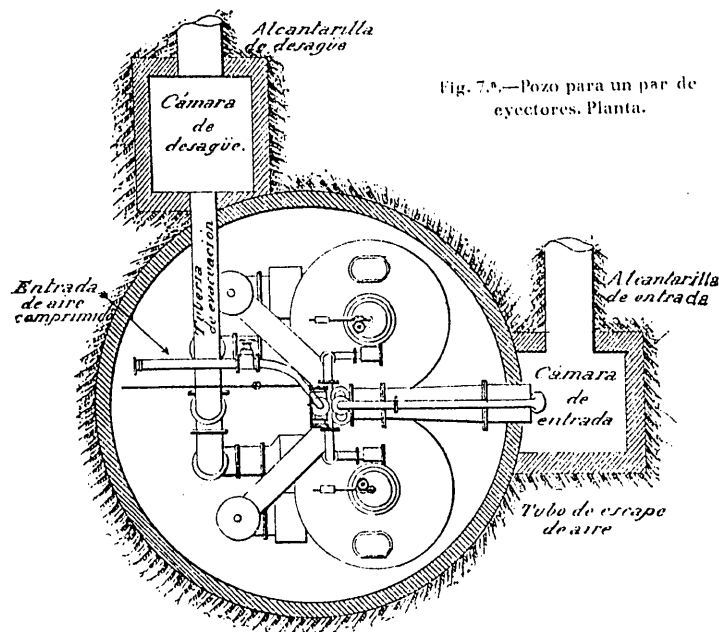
^a.—Pozo para un par de eyectores. Planta.
